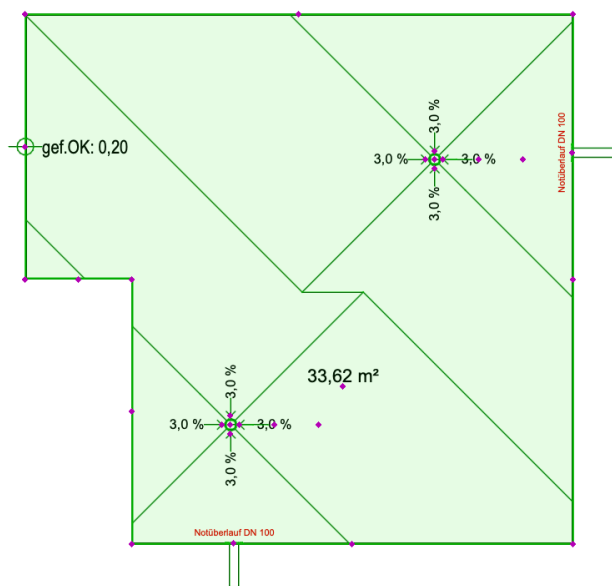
· Grundriss nach den Schritten 2 und 3: polygonale Kontur mit Eck- und Mittelpunkt-Fangpunkten, zwei Tiefpunkten mit je vier Gefällepfeilen, zwei Notüberläufen sowie Höhenkote und Flächentext.
